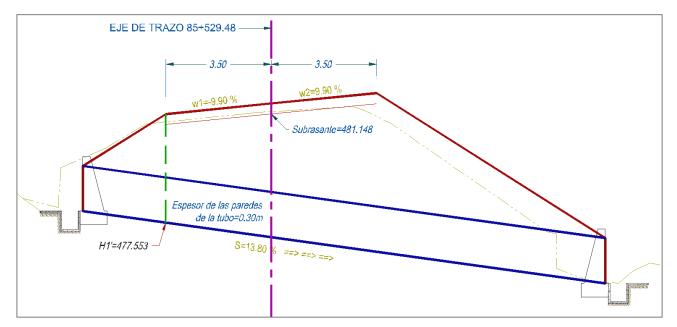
Nivel de desplante sobre eje del hombro más desfavorable en la obra de drenaje 85+529.51. Ilustración, 2018.
